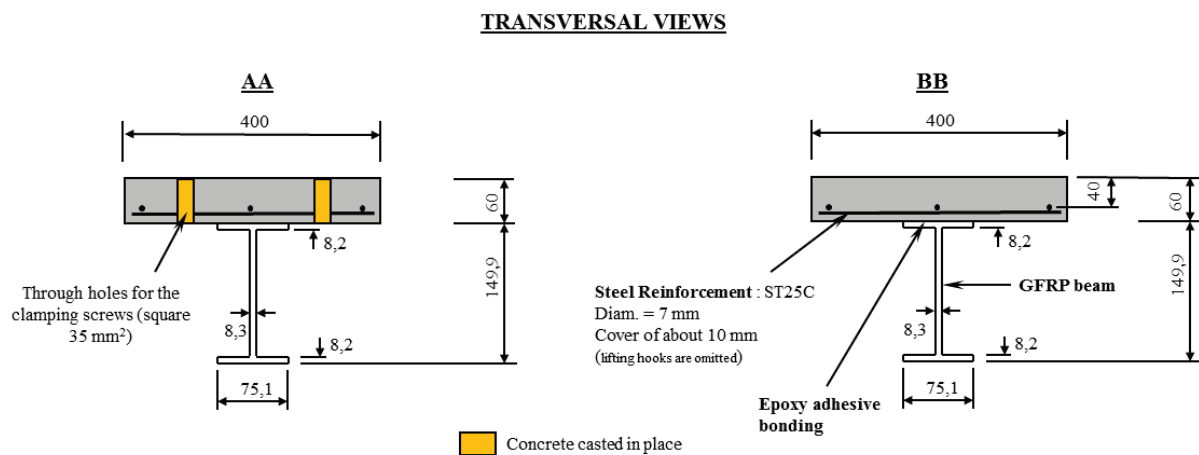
Sections transversales des poutres mixtes PCB2, PCB3, PCB4 et PCB5
